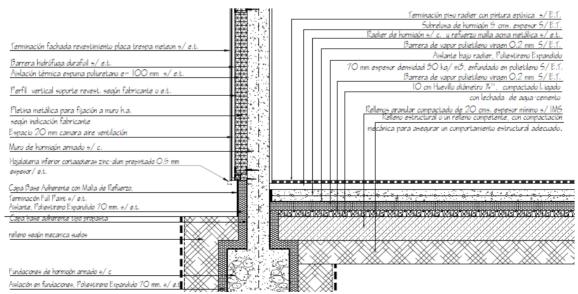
Detalle de radier y muro Fiscalía Local de Ancud.
